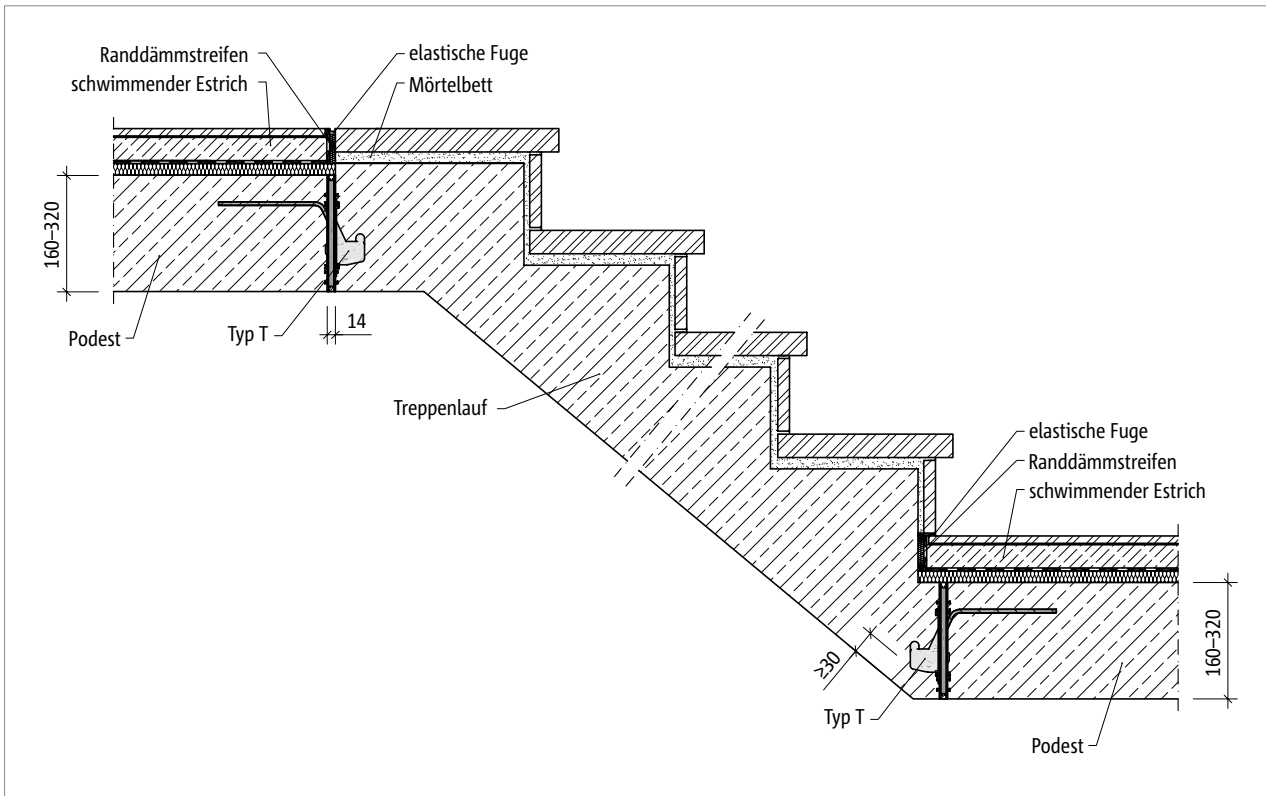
Schöck Tronsole® Typ T: Einbauschnitt
